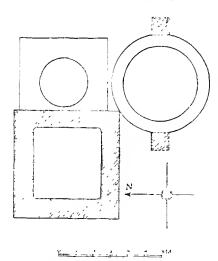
Ķaşr aţ-Ţûba. Der erste Brunnen. Grundriß.
